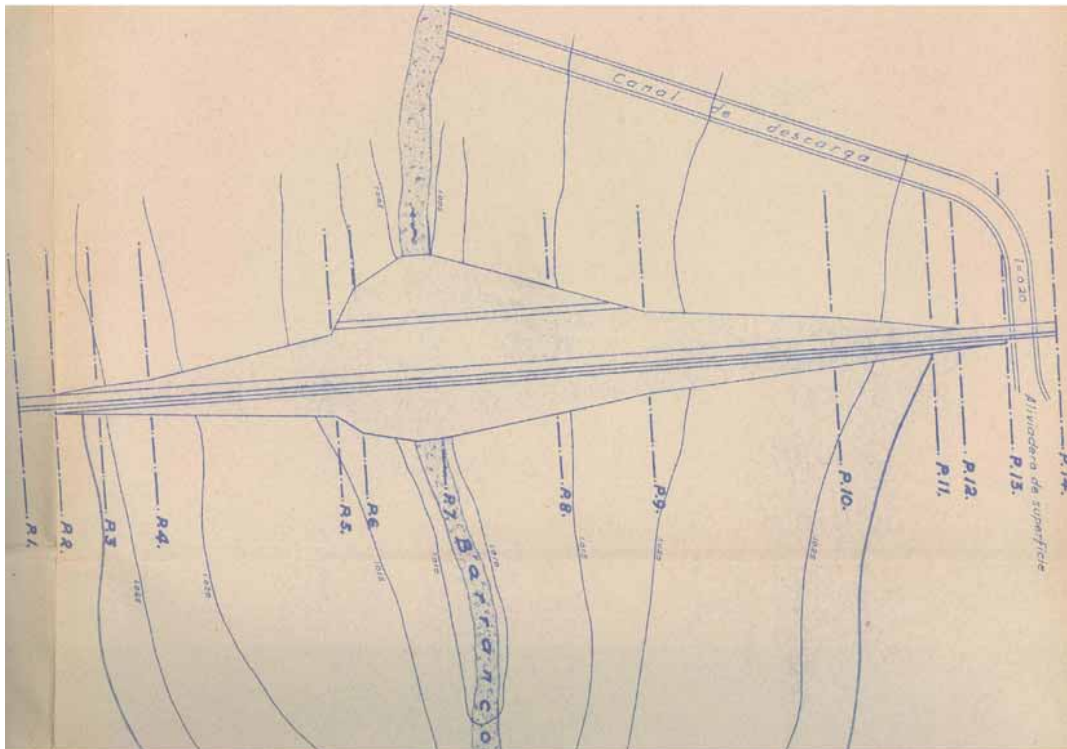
Planta del embalse N° 3 del Proyecto de 1943
